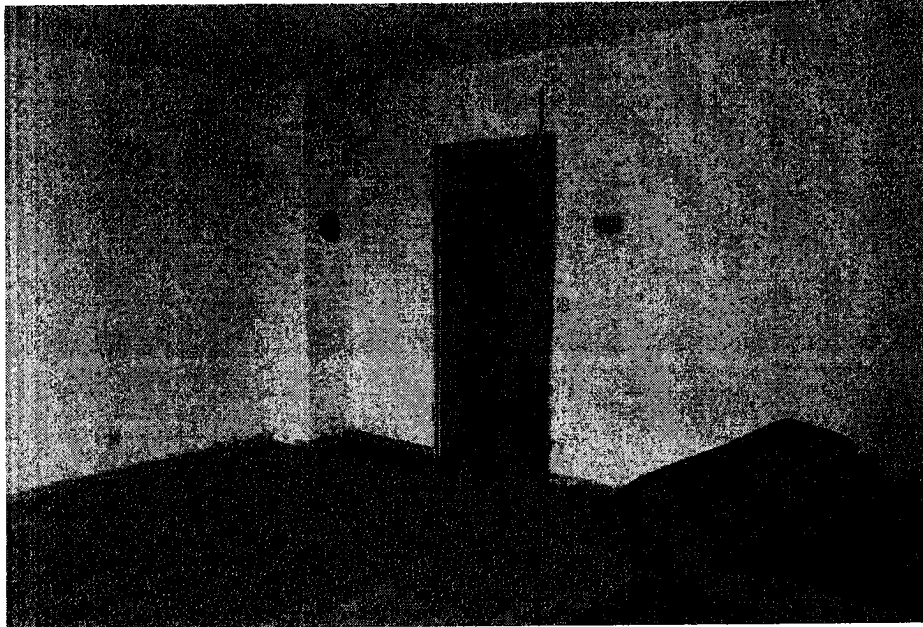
Erdgeschoss Wohnzimmer, mit ehemaligem Kaminanschluss
